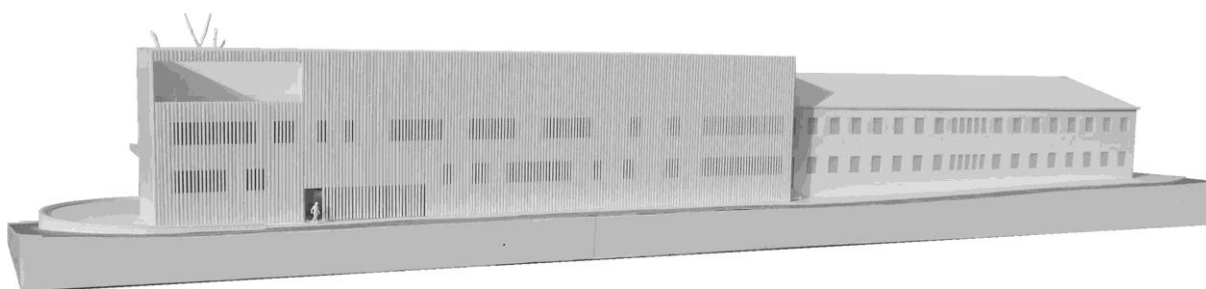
Maqueta final | alçado Nascente | Escala 1:200
